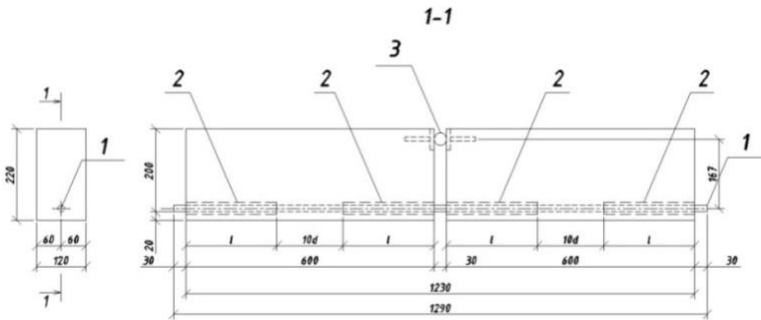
Конструкція дослідного зразка - бетонної балки:
